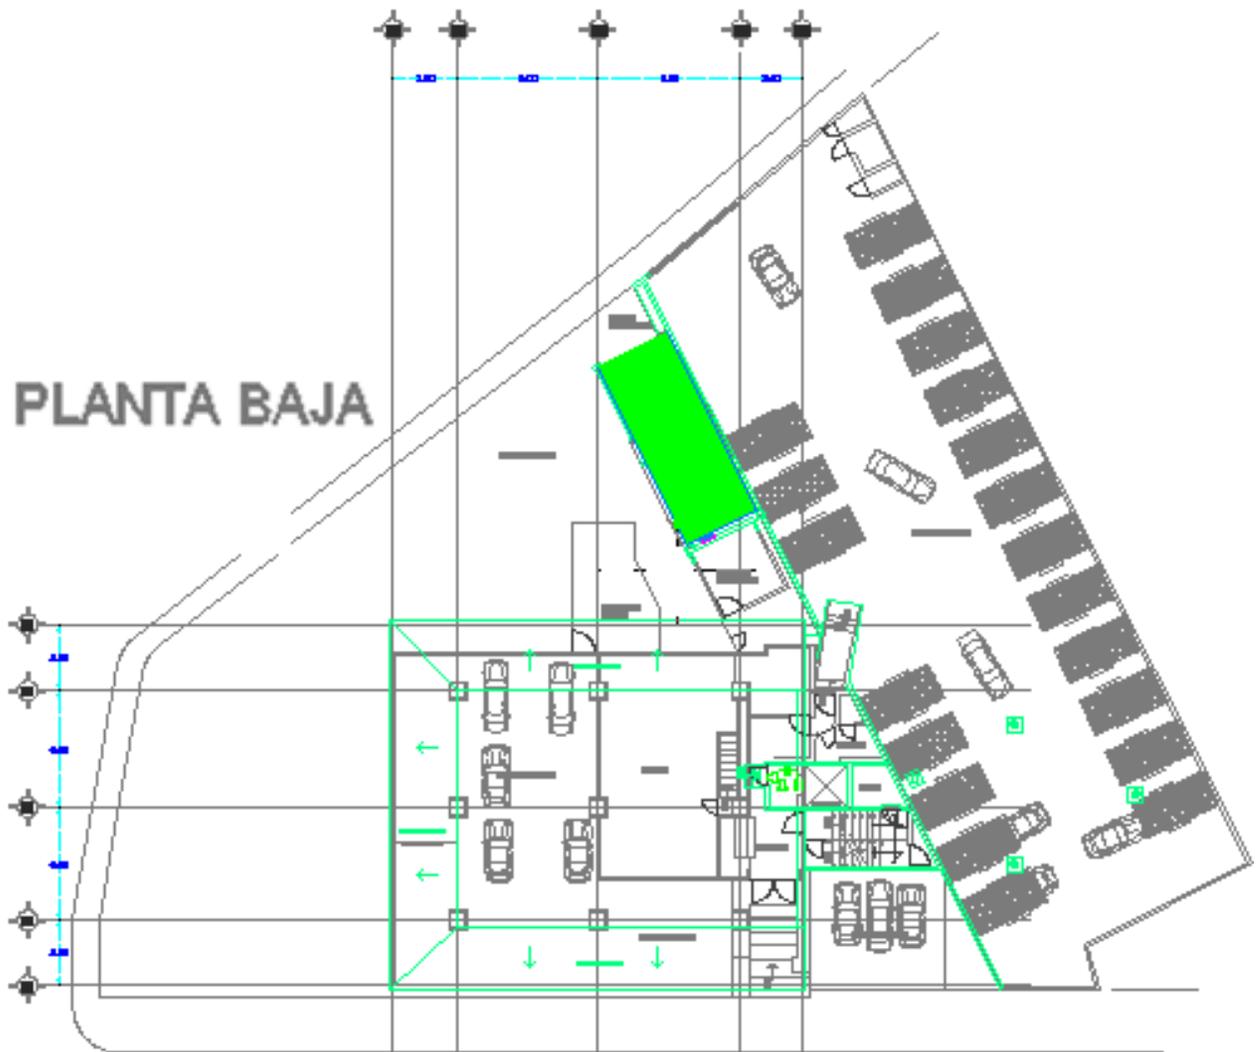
Área disponible para la subestación eléctrica en planta baja (área en verde).
